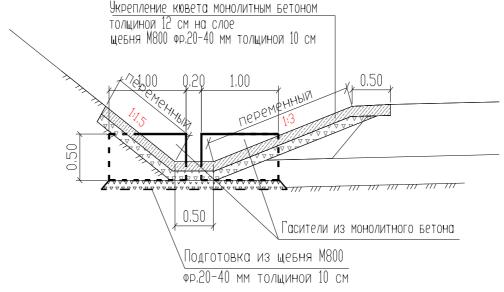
Фрагмент плана кювета укрепленного монолитным бетоном.
